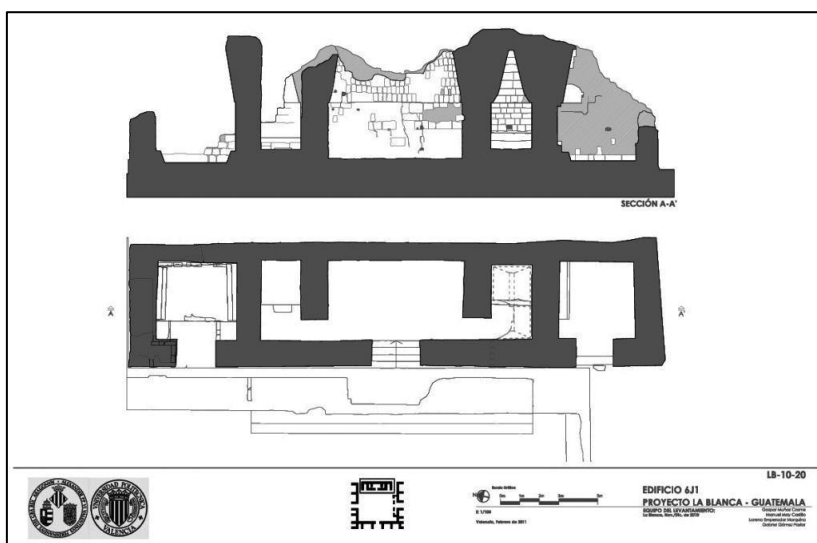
Alzado y planta del Edificio 6J1 o Palacio de Oriente (Muñoz y Vidal, 2014:48).
